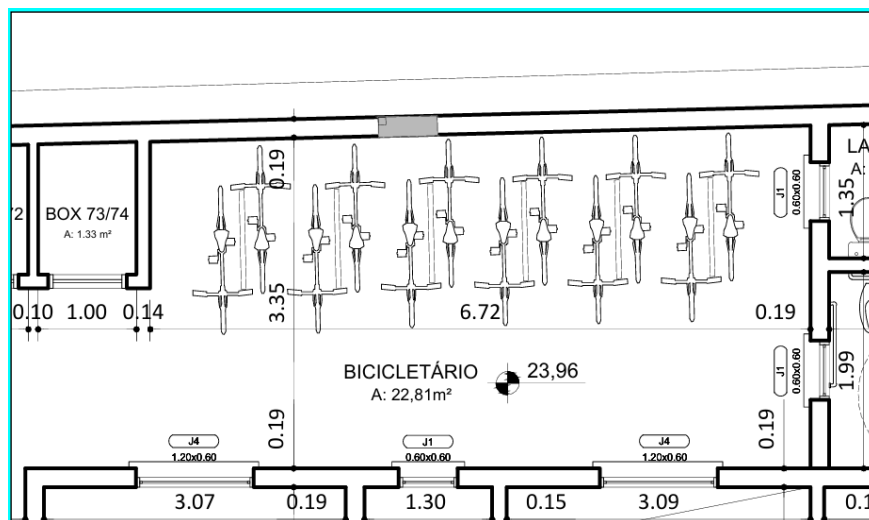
Bicicletário no pavimento térreo. Fonte: Projeto Arquitetônico,
